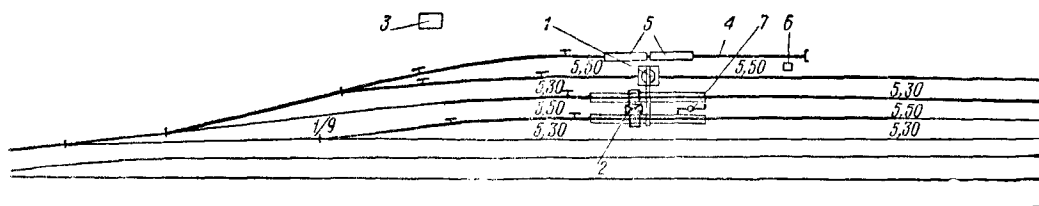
Расположение комплексных устройств для экипировки паровозов на приёмо-отправочных путях: 1—скреперная установка для погрузки шлака; 2—скиповая шлакоуборка с тоннелем для скипа под путями; 3—грейферный кран ПК-6; 4—ленточный транспортёр для подачи угля; 5—повышенный путь для разгрузки угля; 6—смотровая канава; 7—гидроколонка; 8—гидрант для заливки шлака; 9—служебное помещение
